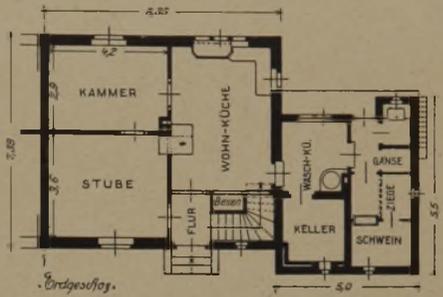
u. 11 (hierunter). Grundrisse des Dienstwohngebäudes des Präsidenten der R. B. D. Oppeln. (1 : 300.) Vgl. hierzu Abb. 1, S. 97.
